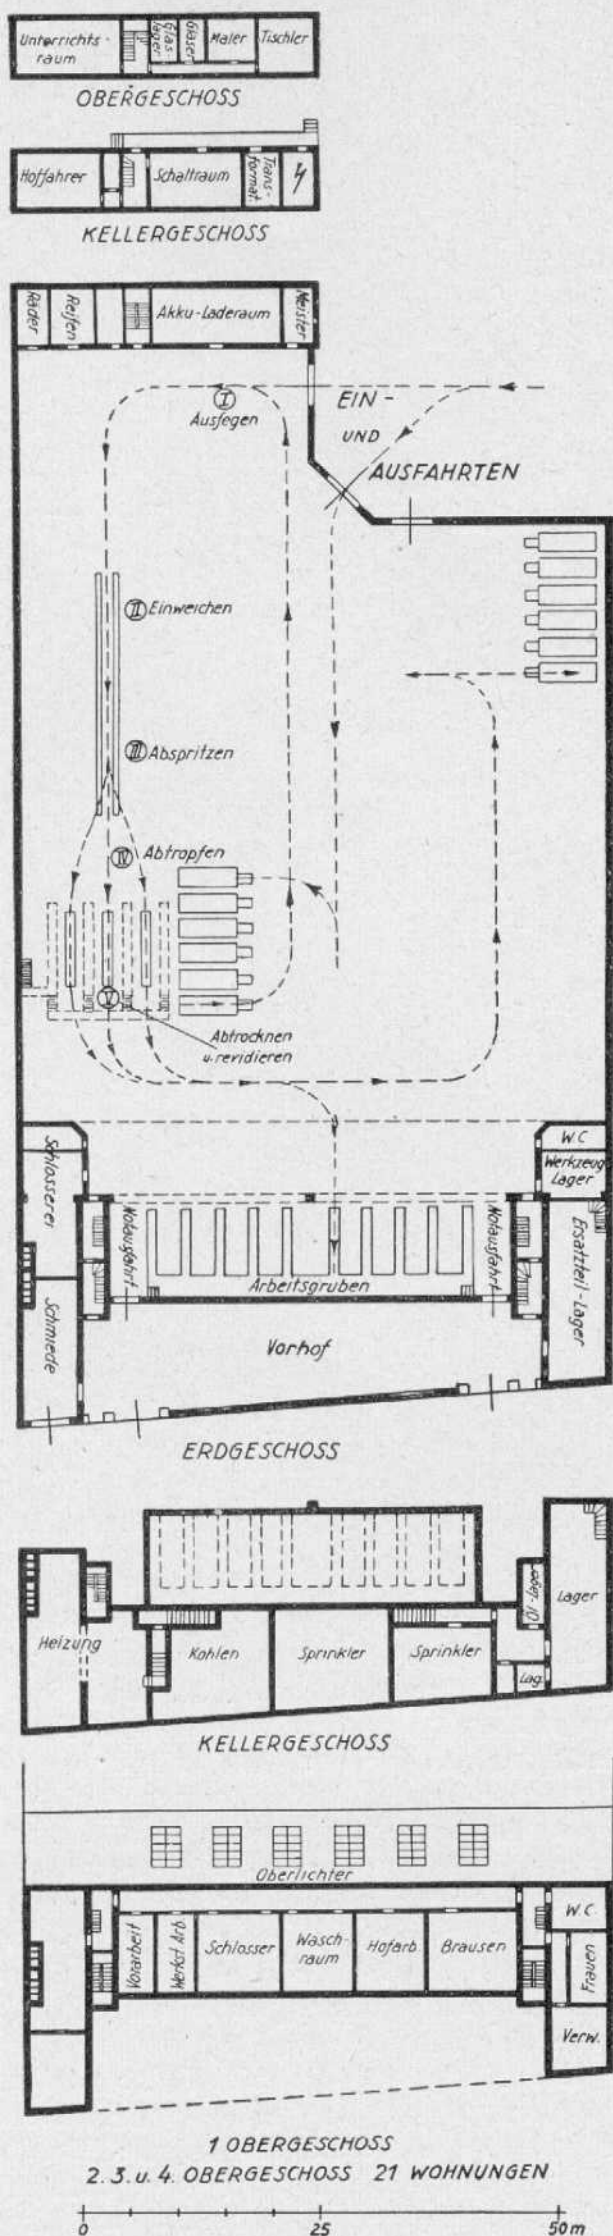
Grundriss der neuen Halle des Omnibus-Betriebshofes Usedomstrasse.
